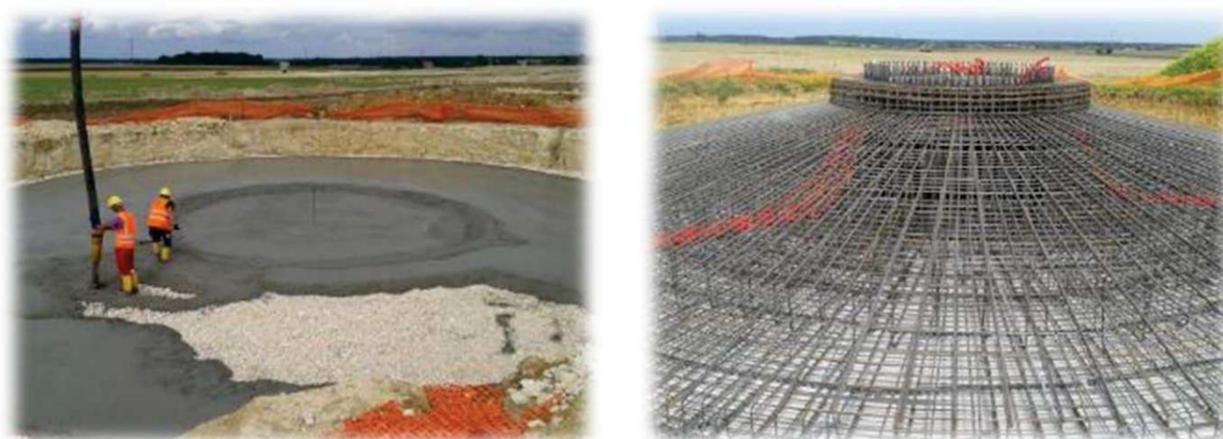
coulage du béton de propreté (à gauche) et ferrailage du massif de fondation (à droite)
